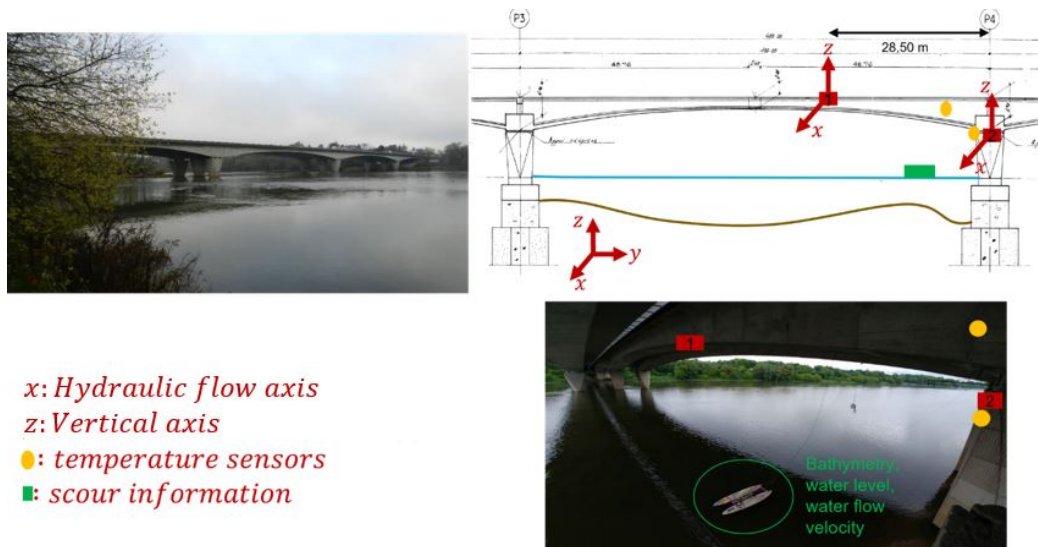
Plan d'instrumentation de l'ouvrage.
